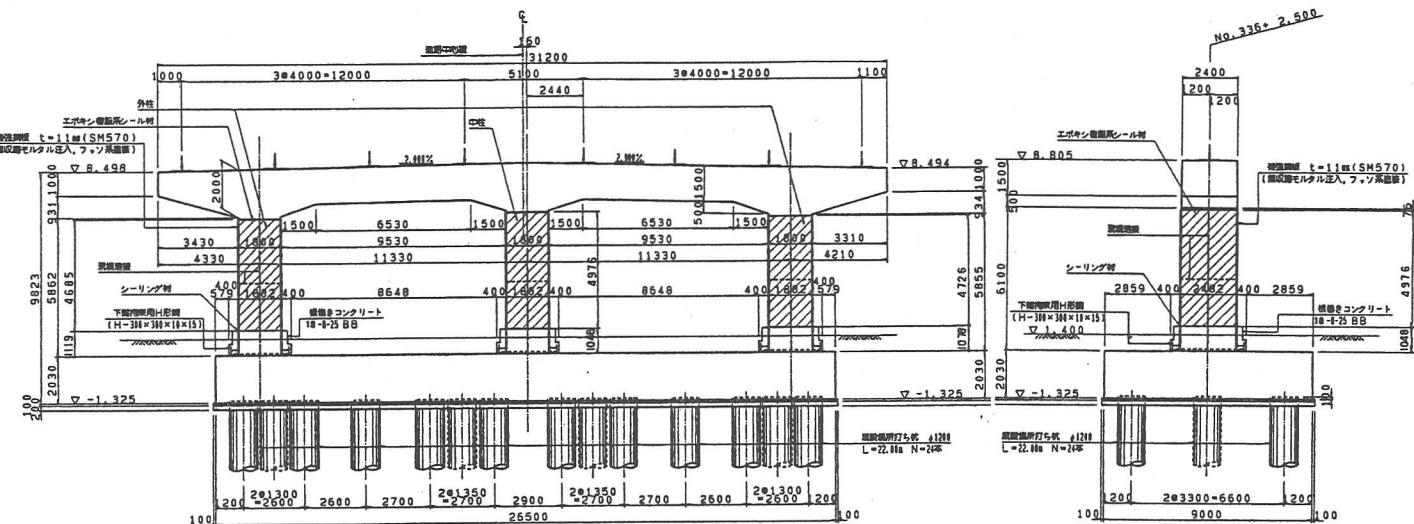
RC 橋脚の鋼板巻立て工の施工標準図
